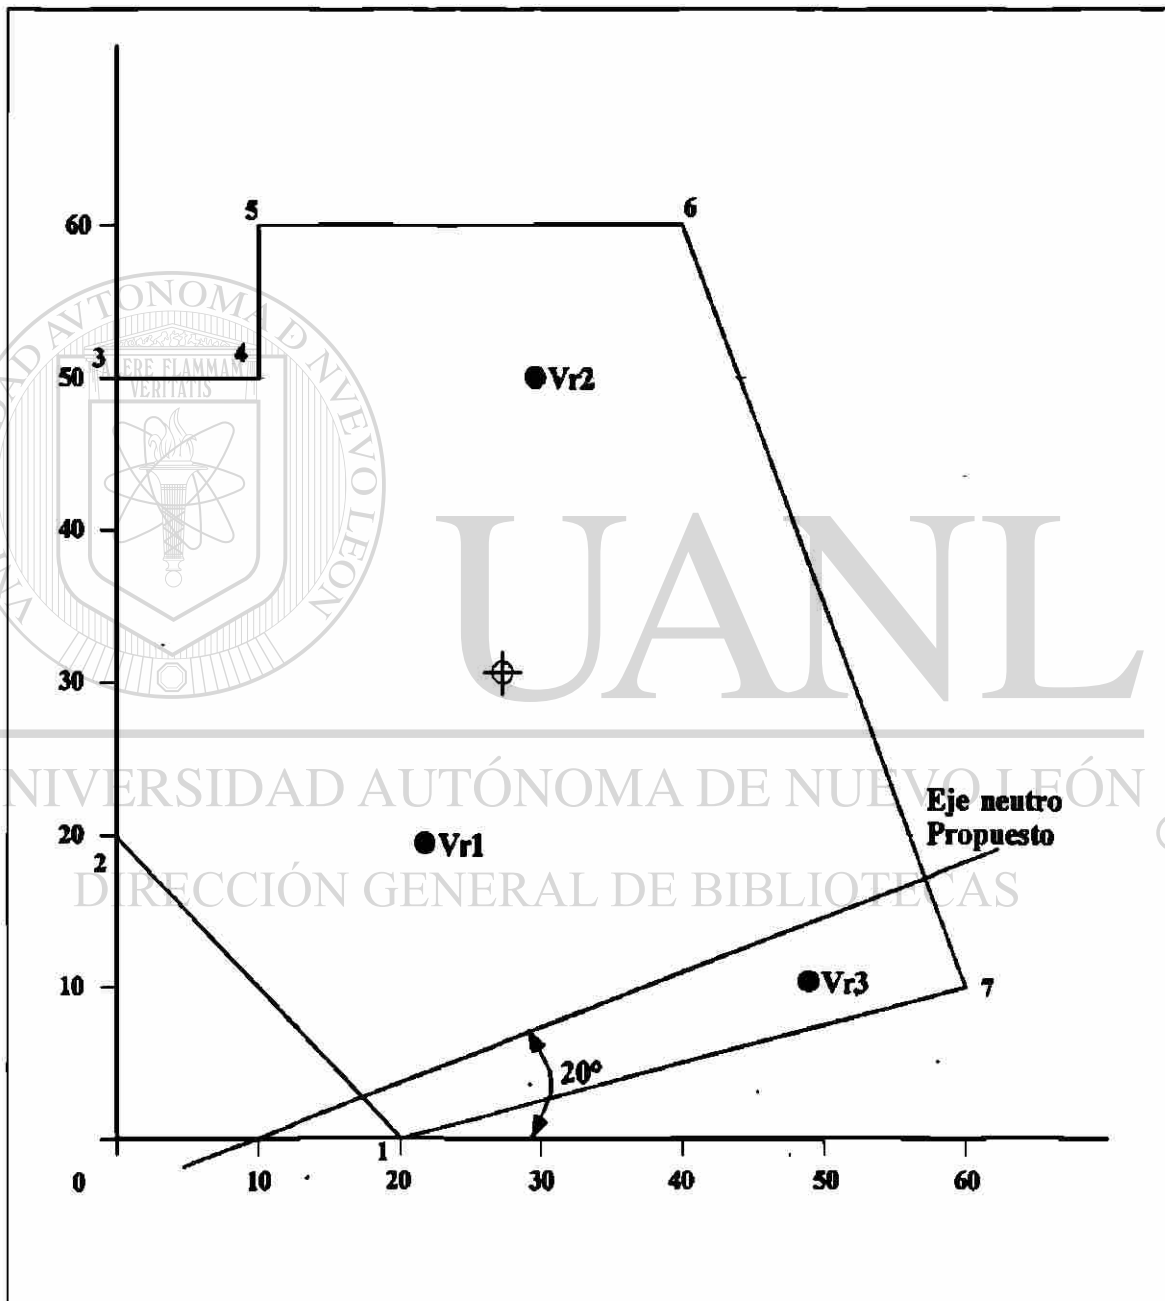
Geometría de columna y ubicación del acero de refuerzo. Coordenadas en cm.
